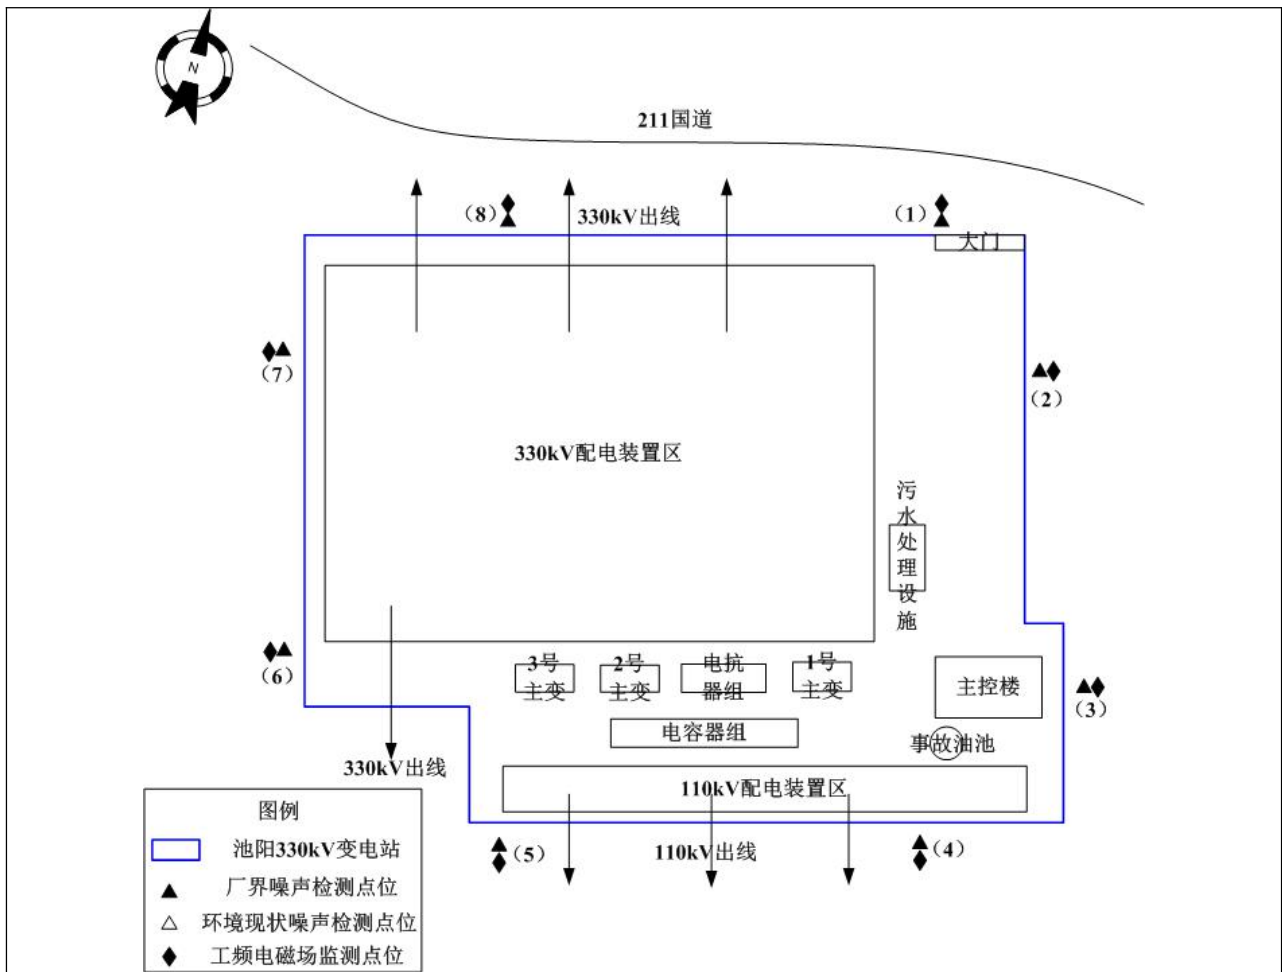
池阳 330kV 变电站平面布置及监测点位图
